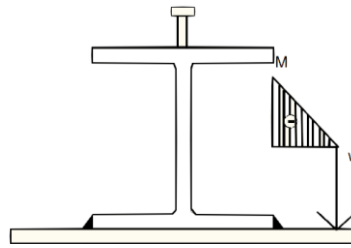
Momento transversal M no banzo inferior metálico, numa viga do tipo ASB (BARROS,2011)
